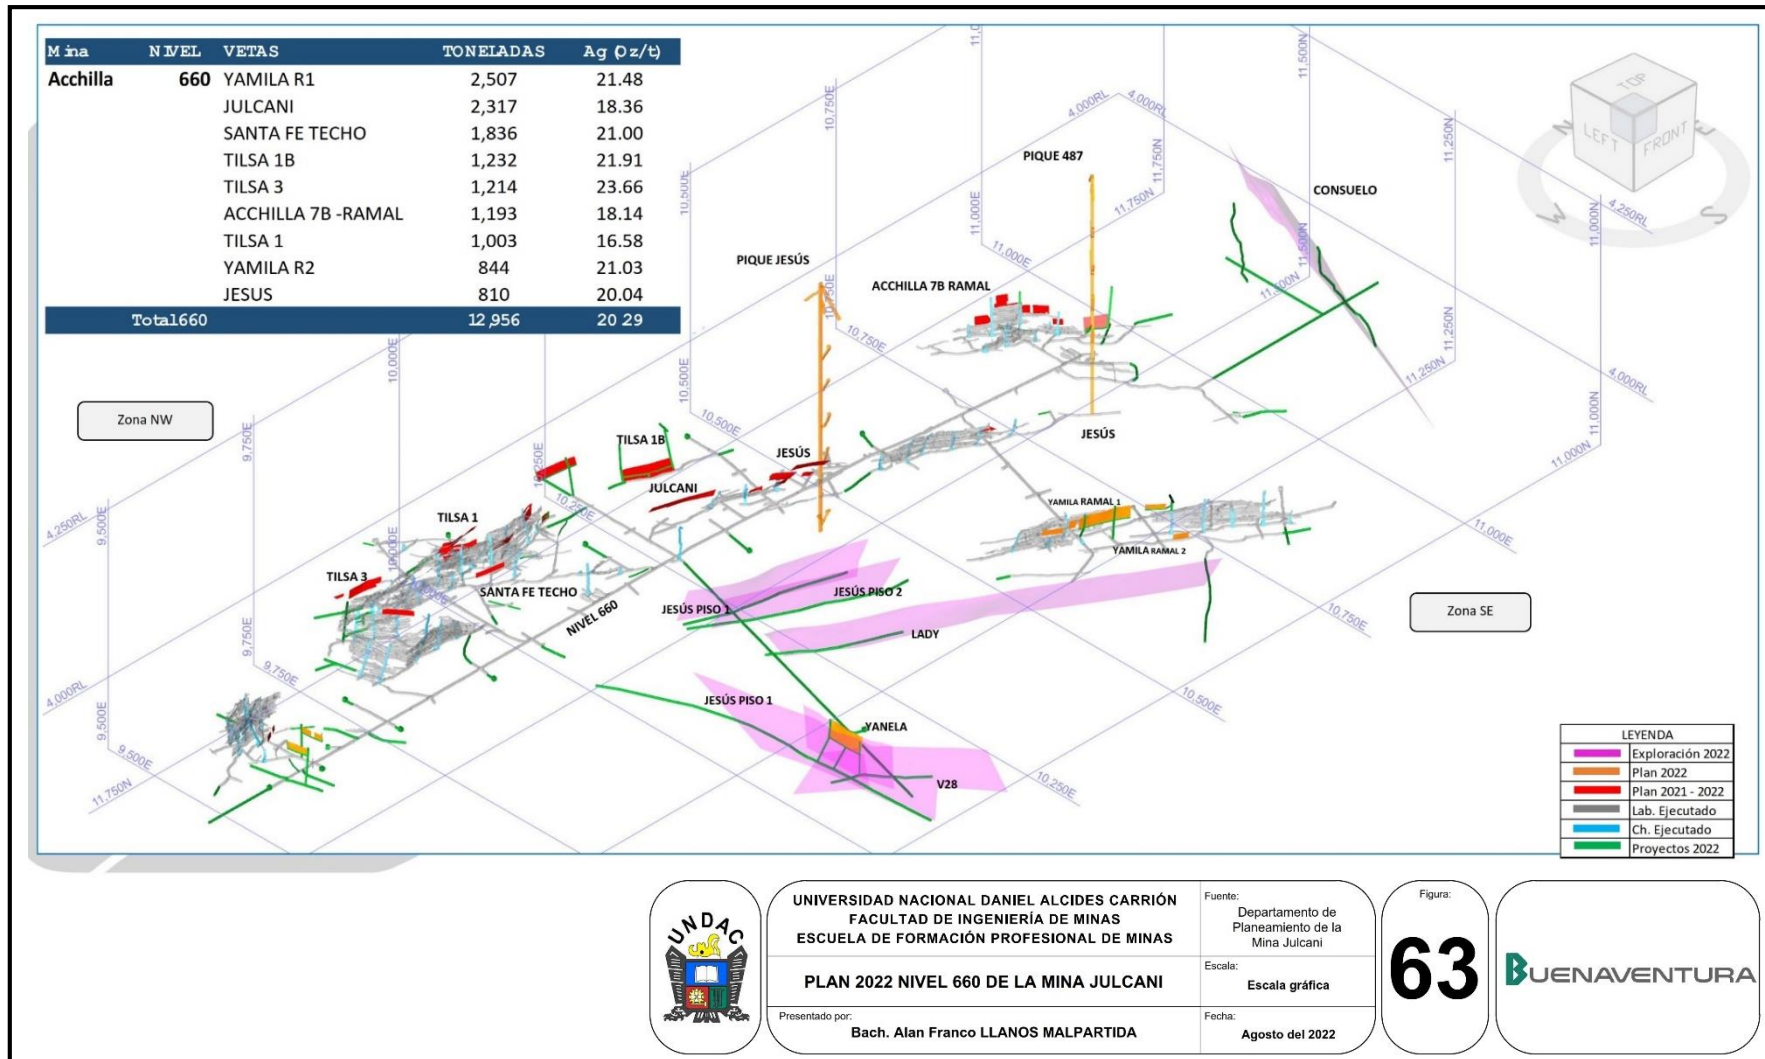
Plan 2022-Nivel 660 de la Mina Julcani.
